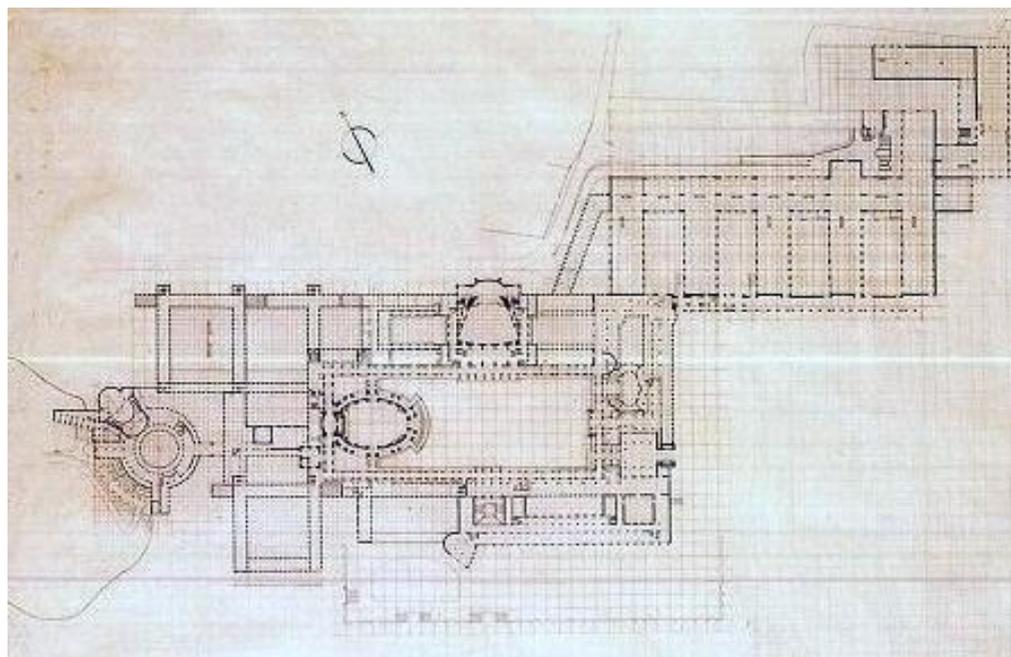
Planta General de Ordenación del Conjunto según Proyecto Final del equipo dirigido por Luis Moya.
